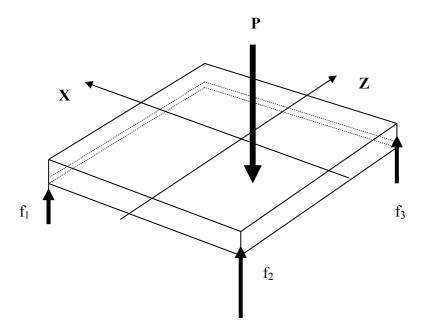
Presiones de contacto en una zapata aislada excéntrica
